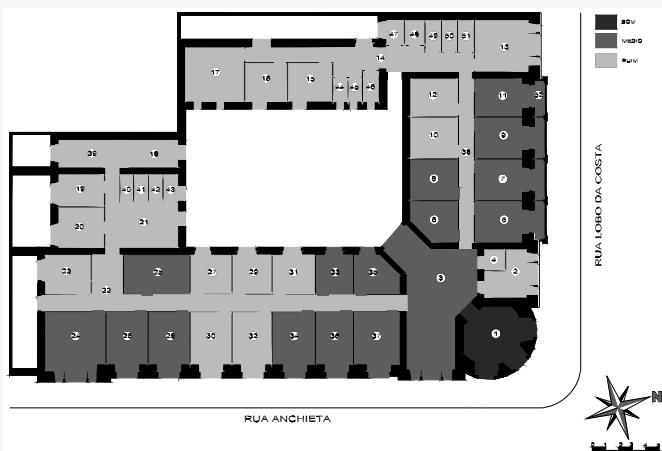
Planta Baixa do 3º Pav. – Estado de Conservação. Desenho: Cristiane Müller.
